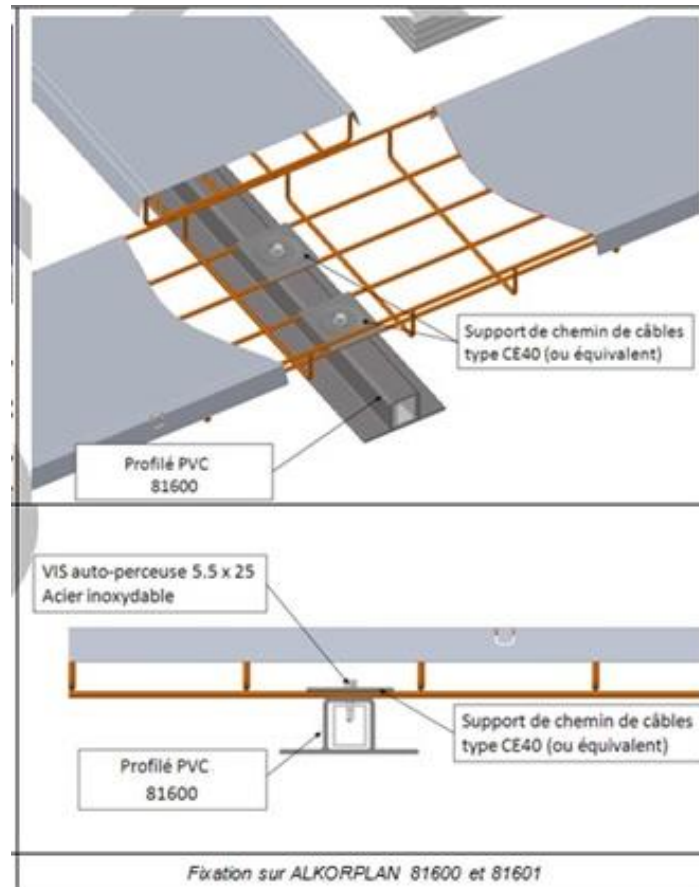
Illustrations de la fixation des chemins de câbles par des supports type CE 40
